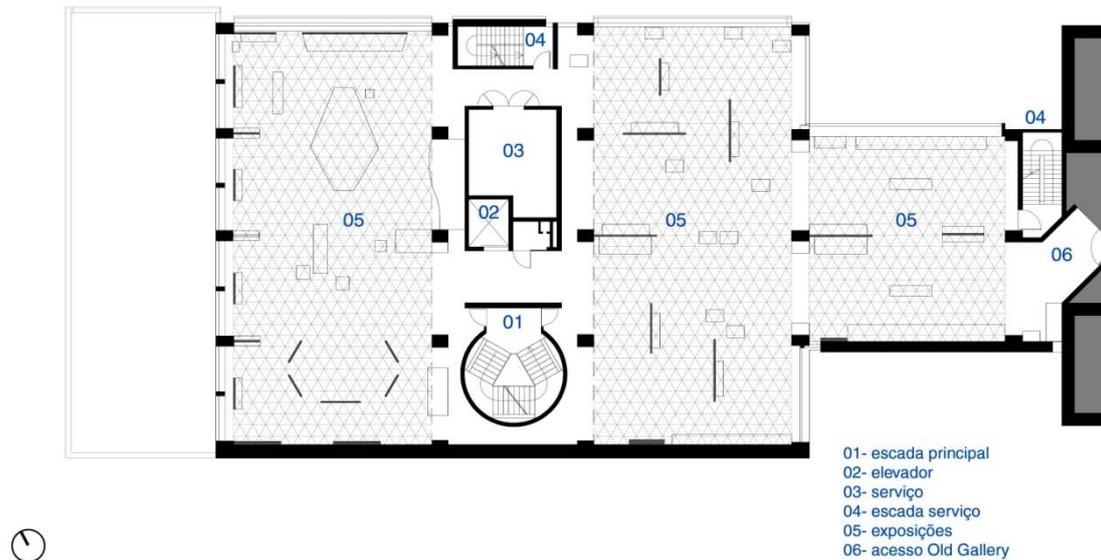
| Planta 2º ao 4º pavimento YUAG [redesenho do autor]
